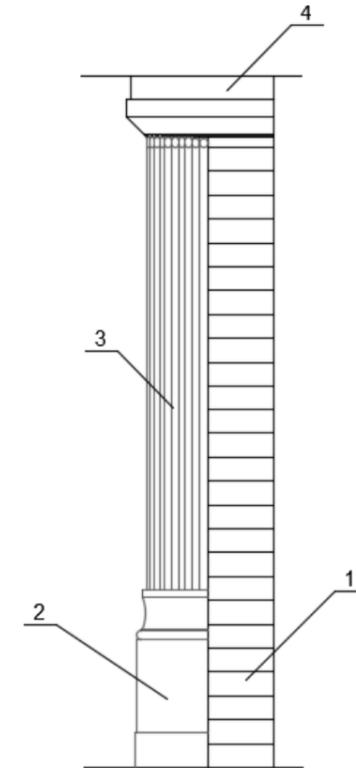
Estación del Norte. París. Recreación muro fachada. Fuente: Propia. Escala: 1:50.
